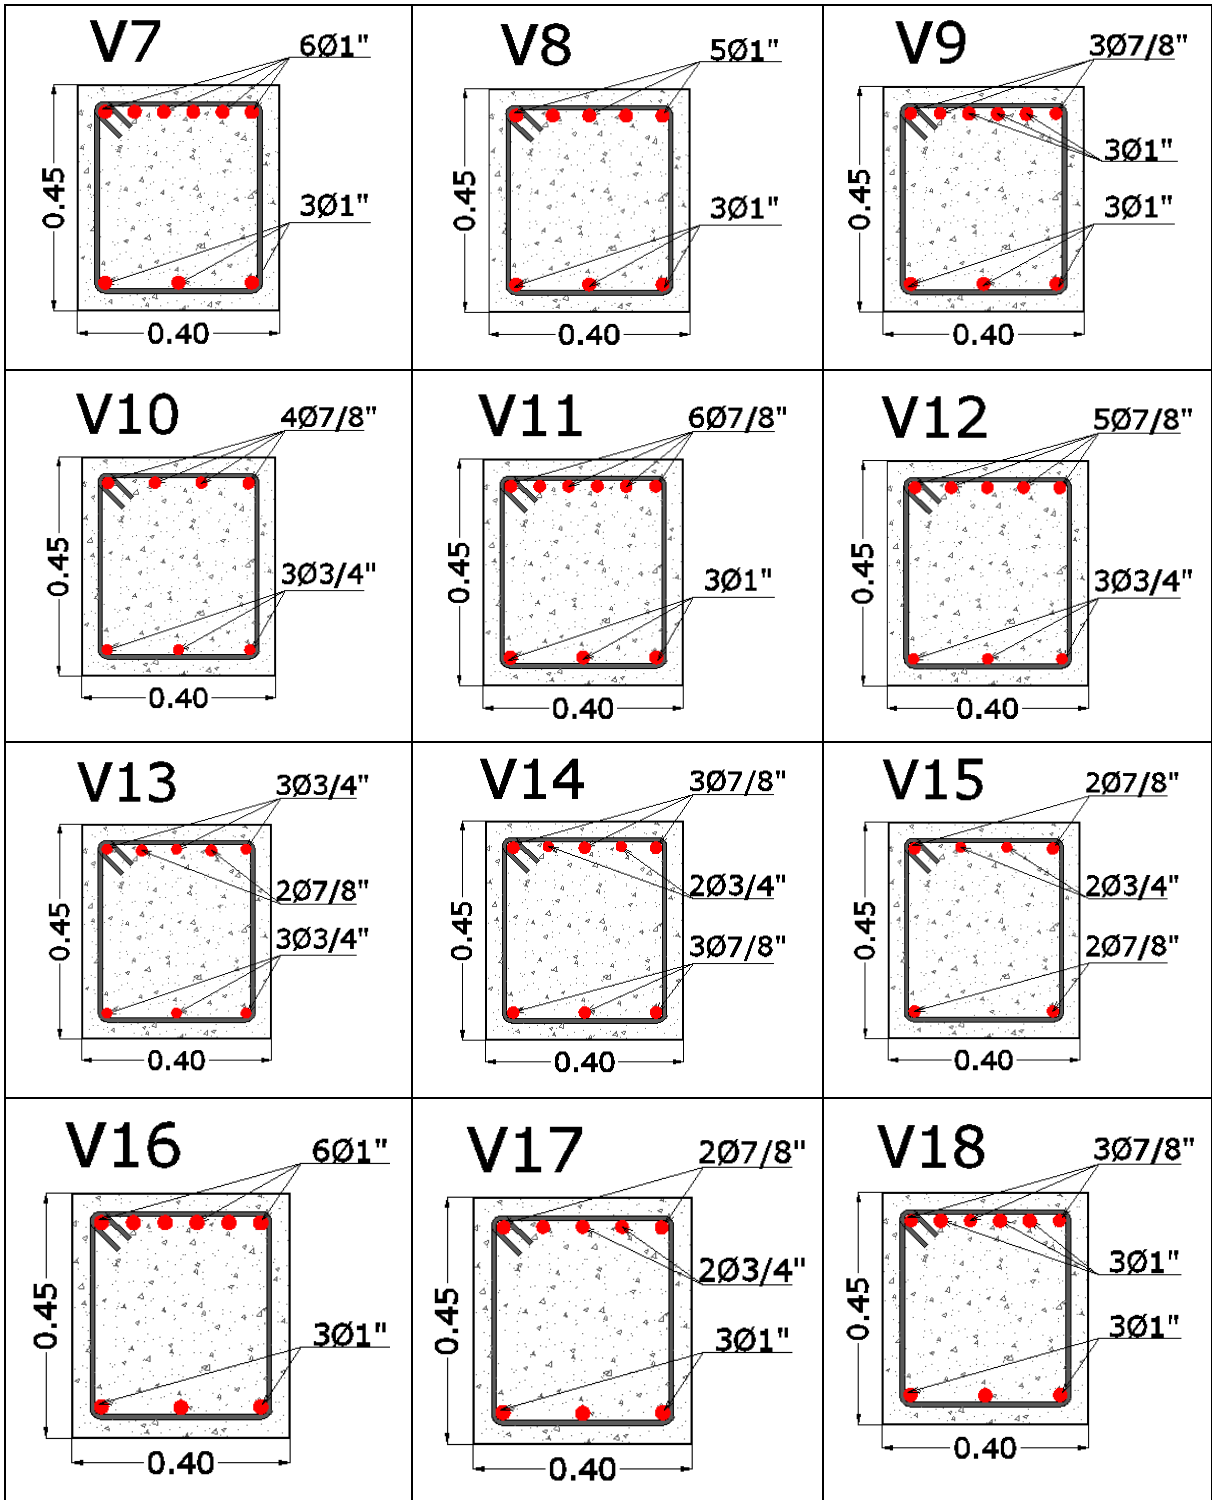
Elementos Tipo Viga – Planta Tipo 2
